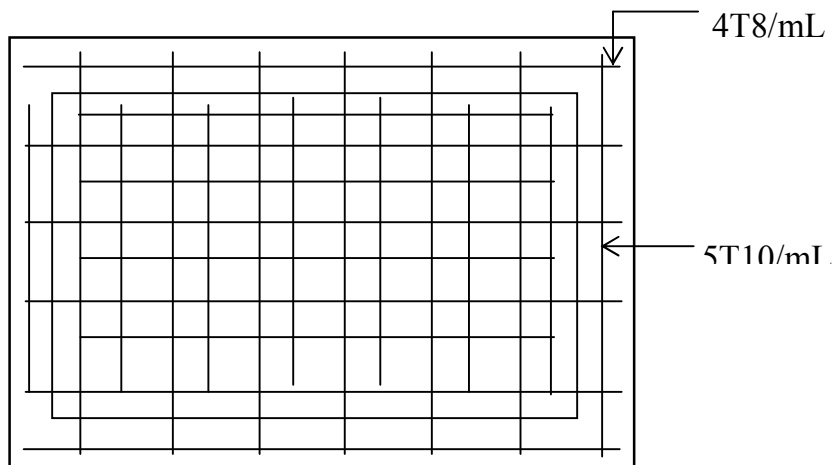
Ferrailage Supérieur du panneau de dalle d'ascenseur
